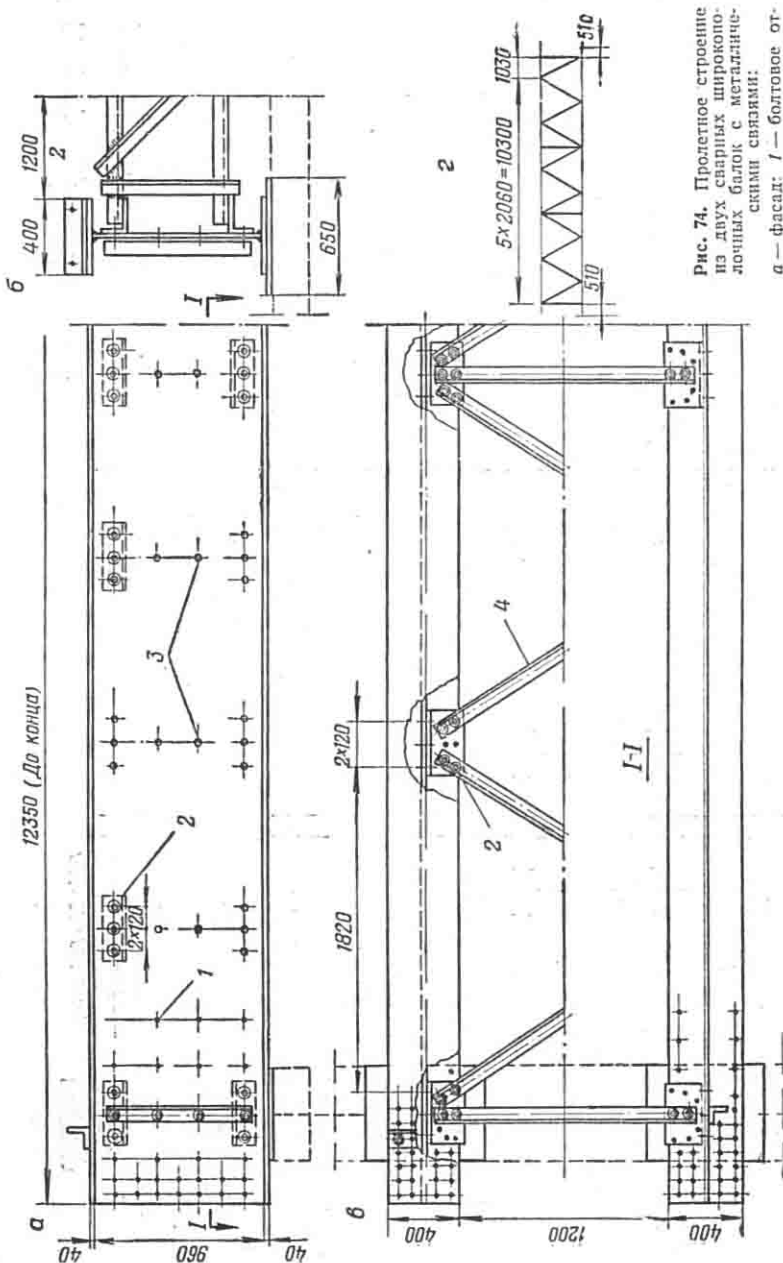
Пролетное строение на двух сварных широкополочных балках с металлическими связями:
